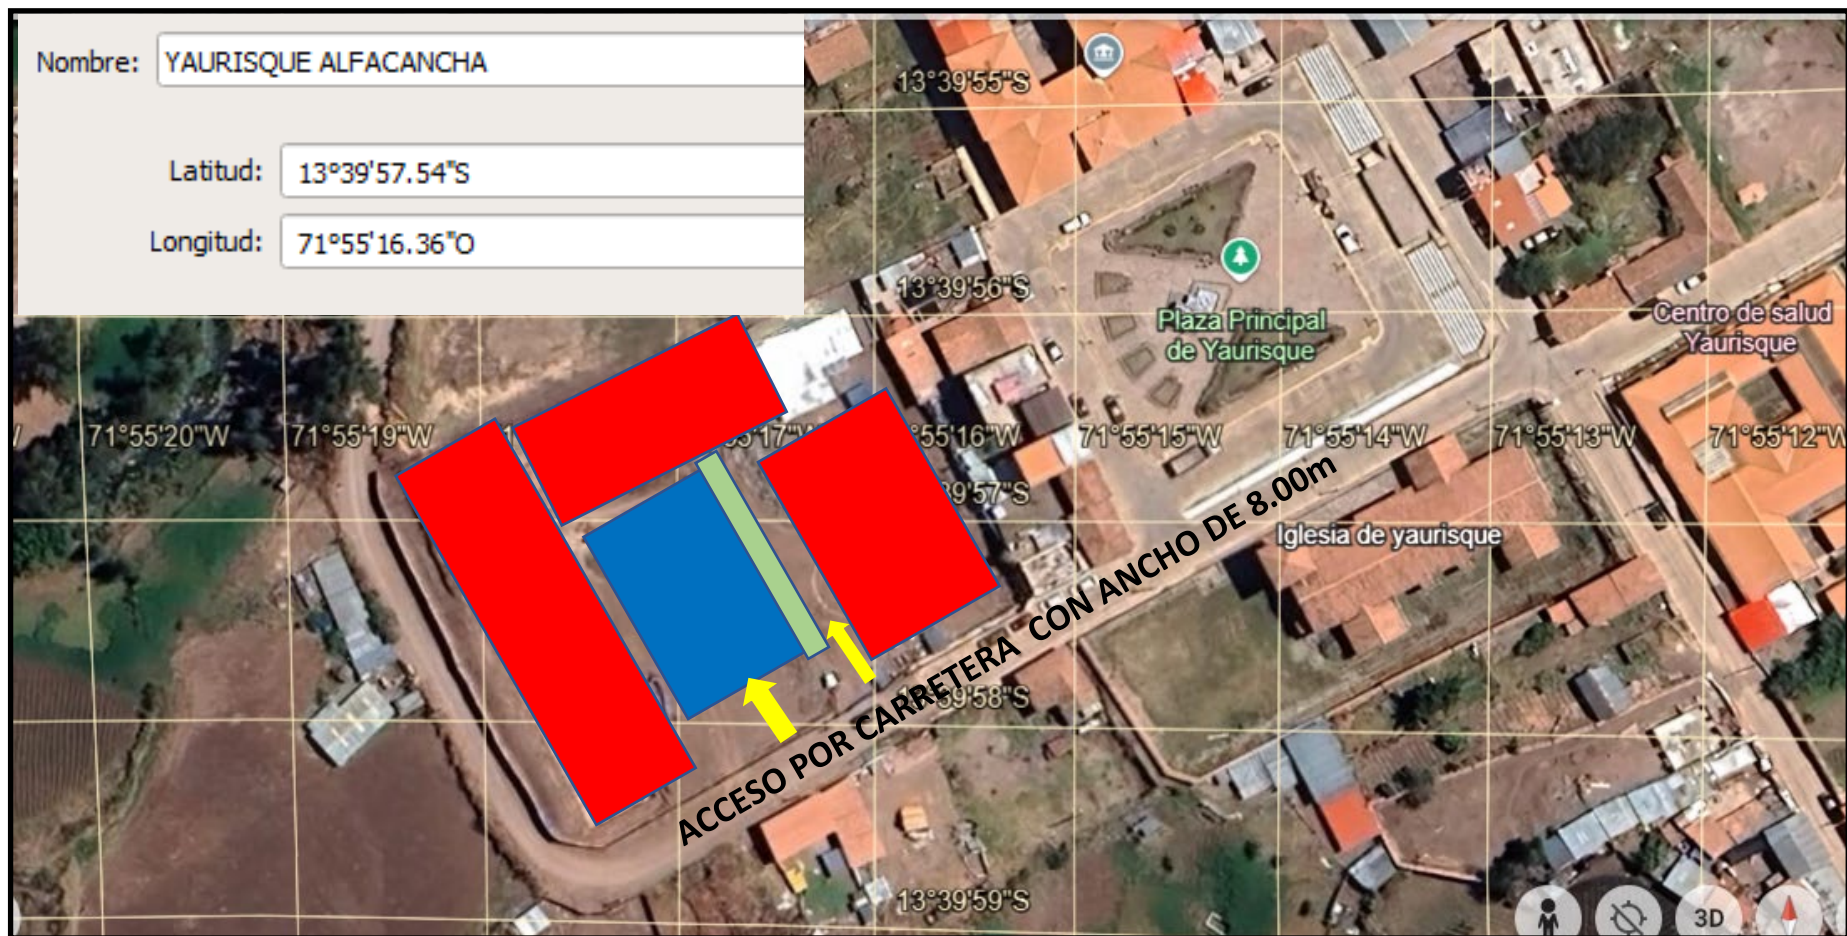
IMAGEN : LOSA DEPORTIVA(RECTANGULO COLOR AZUL) SI SOPORTA LAS LLANTAS DE ANDAMIO; RECTÁNGULO COLOR VERDE TRIBUNA; NO DEBERA ACCEDER EL CAMION GRUA A LA LOSA DEPORTIVA QUE SE ENCUENTRA VACEADA CON CONCRETO ; ACCESO DESDE LA CARRETERA ADYASCENTE AL PROYECTO(FLECHAS AMARILLAS); RECTANGULOS ROJOS AREA CONSTRUIDA A LA LOSA DEPORTIVA; NO ACCEDER CAMIÓN GRÚA EXCEPTO SE BRINDE LA SEGURIDAD Y GARANTÍA NECESARIA DE NO DAÑAR LA LOSA DEPORTIVA CON Espesor =15cm) PUDIENDO SER INSTALADO DESDE LOS LUGARES ADYACENTES EN FUNCIÓN A QUE EL CONTRATISTA LO CONSIDERE Y BAJO TOTAL RESPONSABILIDAD , (PREVER LA SEGURIDAD DEL PERSONAL) ; SI ES POSIBLE INSTALAR ANDAMIOS CON LLANTAS /RUEDAS ENCIMA DE LA LOSA DEPORTIVA , COMO RESPUESTA A LA CONSULTA.
